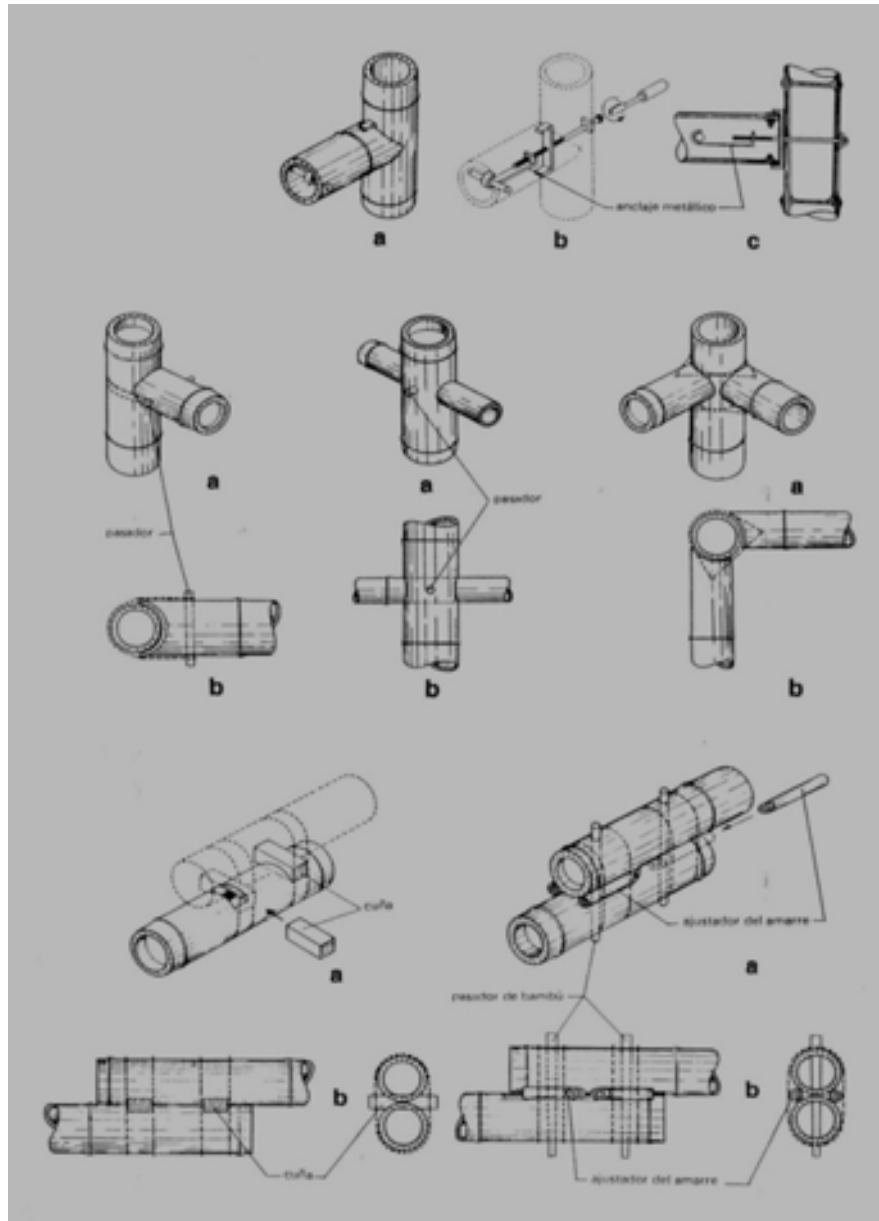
Emprego de fixadores e cravos na união de peças horizontais e verticais.
